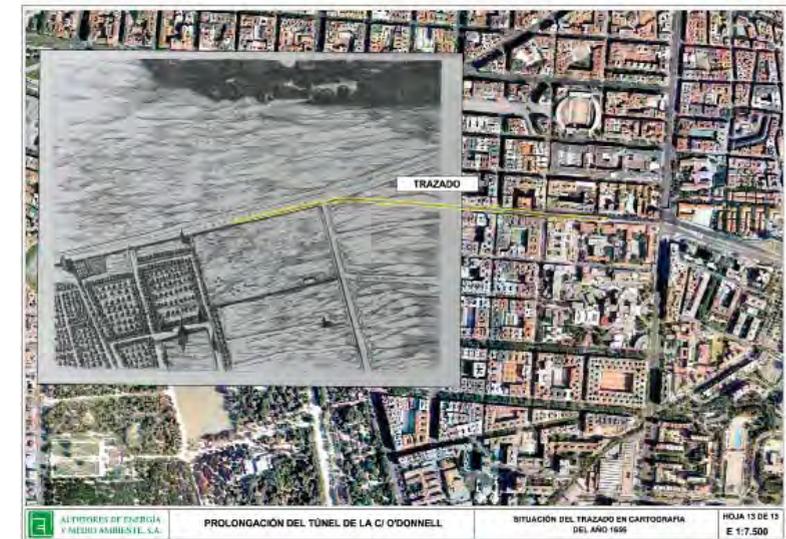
Planimetría con montaje de ortofoto y plano histórico (calle O'Donnell, Madrid).
